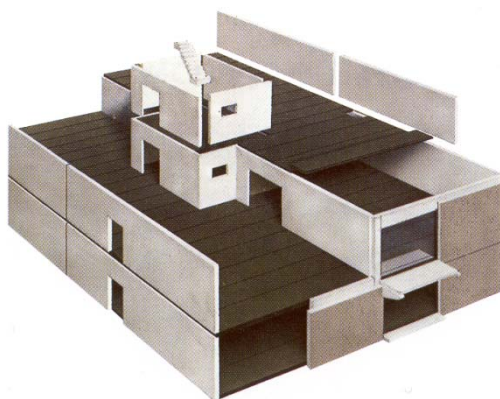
Construção com paredes portantes, perpendiculares à fachada
